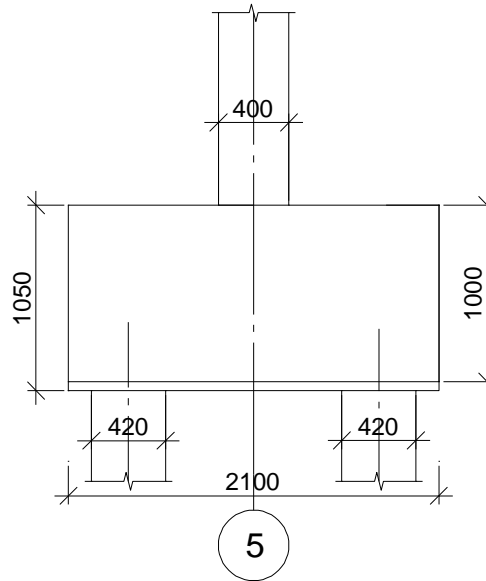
Схема ростверку для розрахунку на продавлювання
